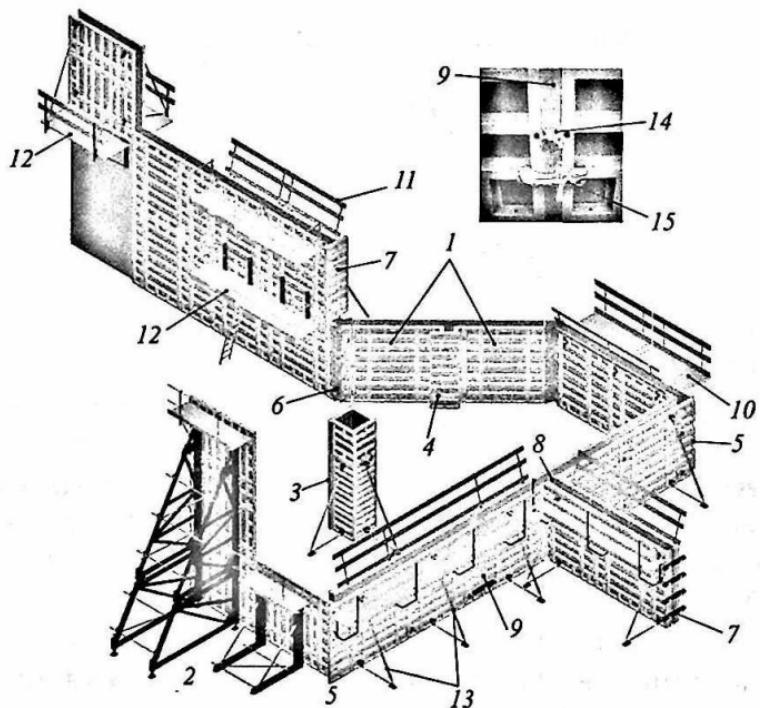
Основные элементы крупнощитовой опалубки для конструкций стен и колонн:
